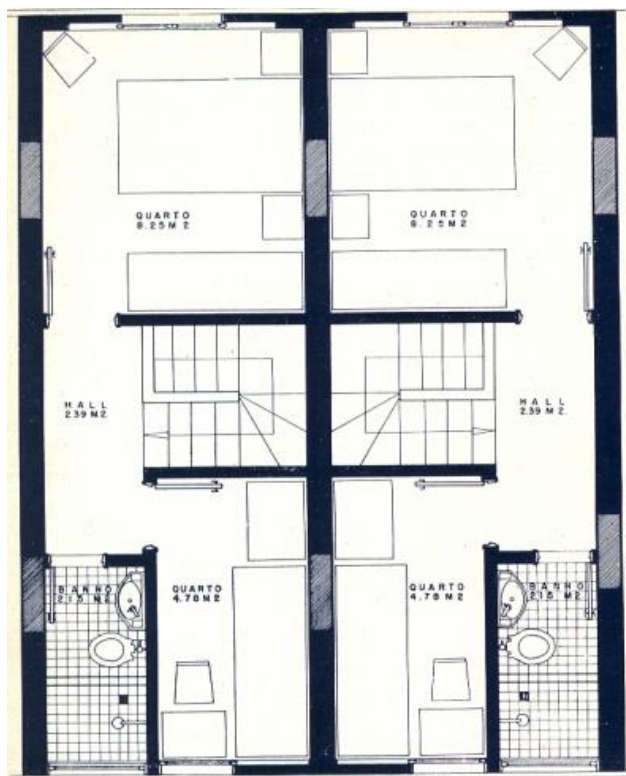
Tipologia duplex - planta baixa do 2º pavimento – fonte: revista Arquitetura Contemporânea
